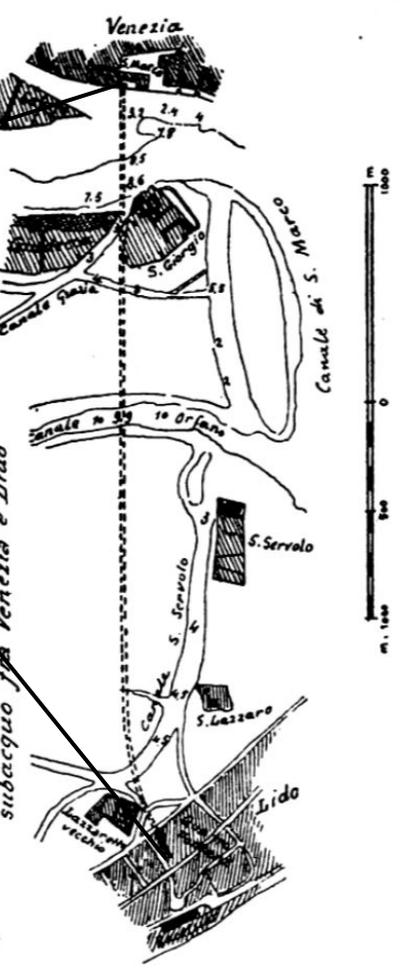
Planimetria generale dell'allacciamento subacqueo fra Venezia e Lido
